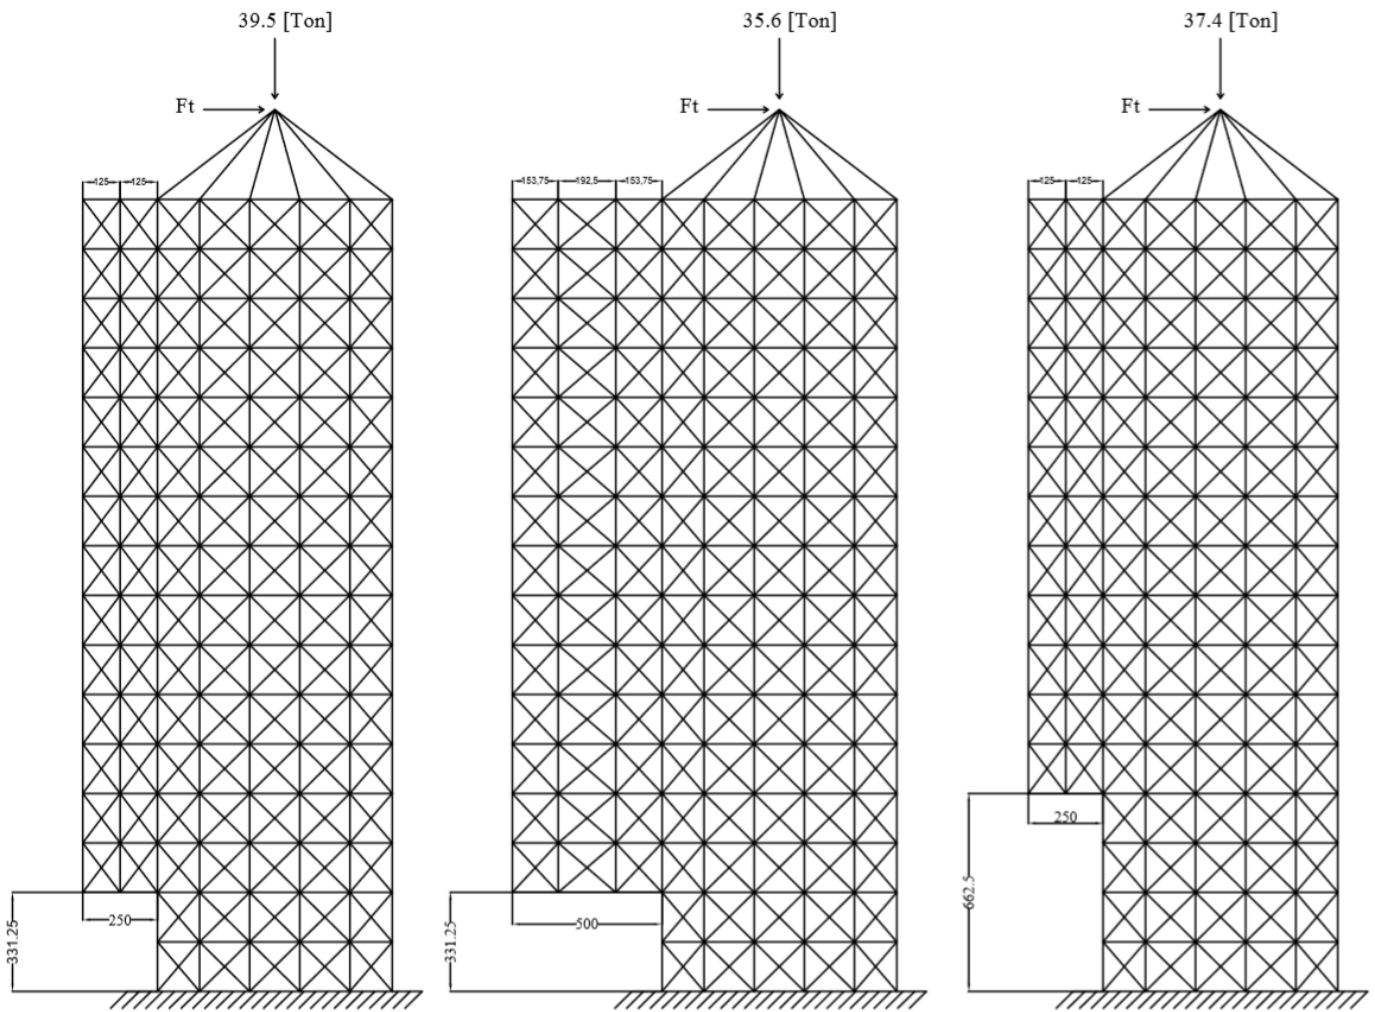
Esquema de los muros modelados. De izquierda a derecha Muro bandera 1, 2 y 3. Dimensiones en [mm].
